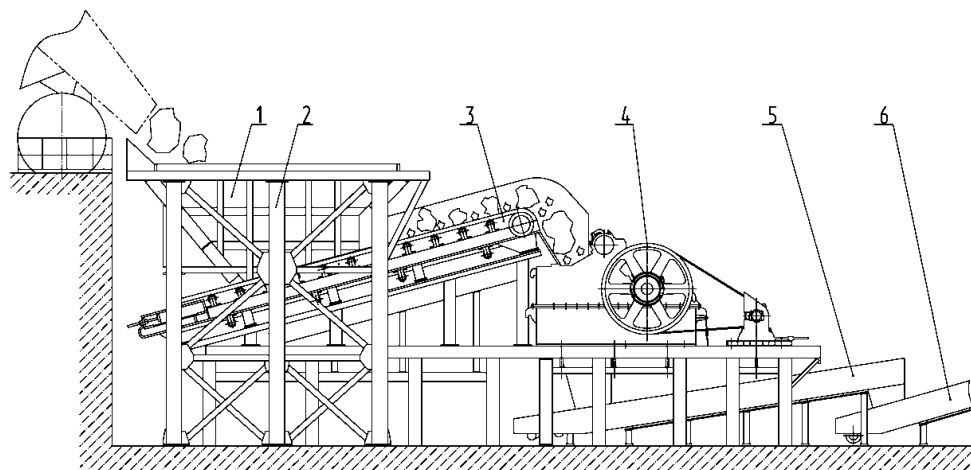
Общий вид дробильно-перегрузочной установки ДПУ-300
